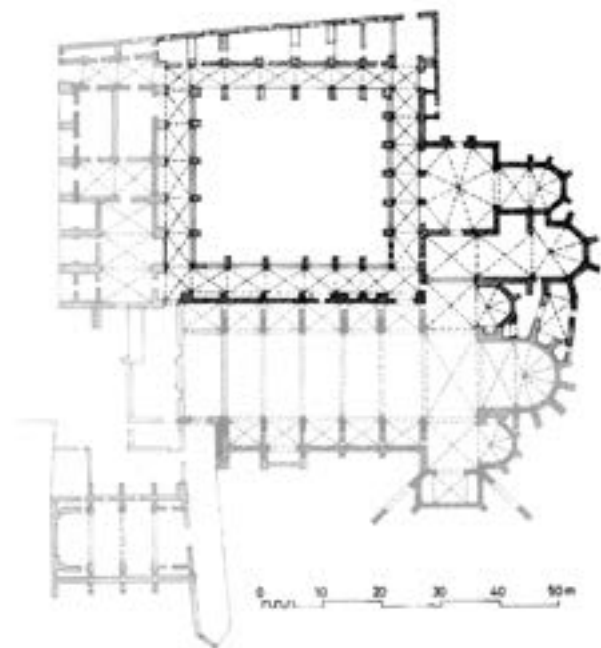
Planta general del convent. Zona d'intervenció en color negre. Elaboració: Fortià arquitectes.
